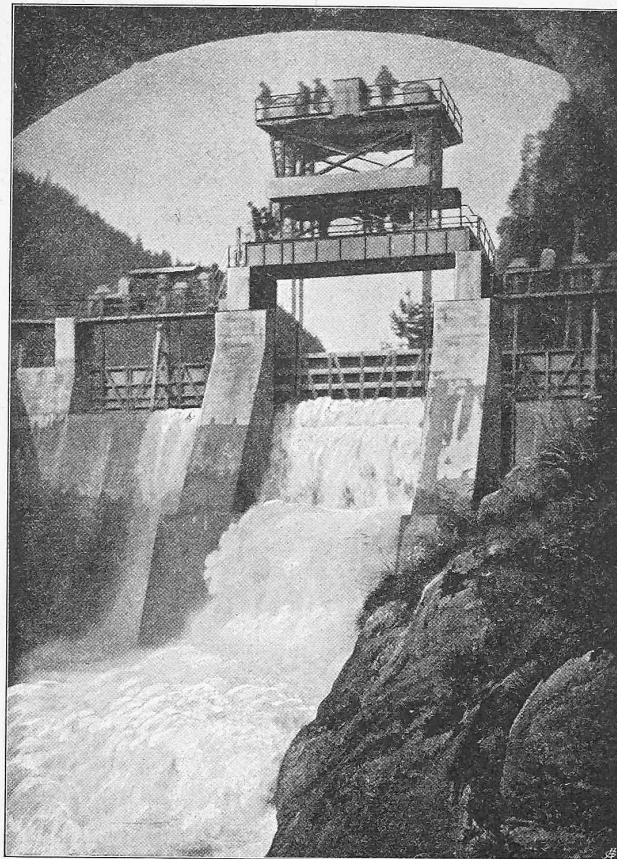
Ansicht des Simmewehrs von unten bei Hebung der untern Grundablassschütze.
